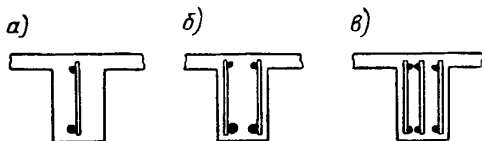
Армирование балок плоскими сварными каркасами
